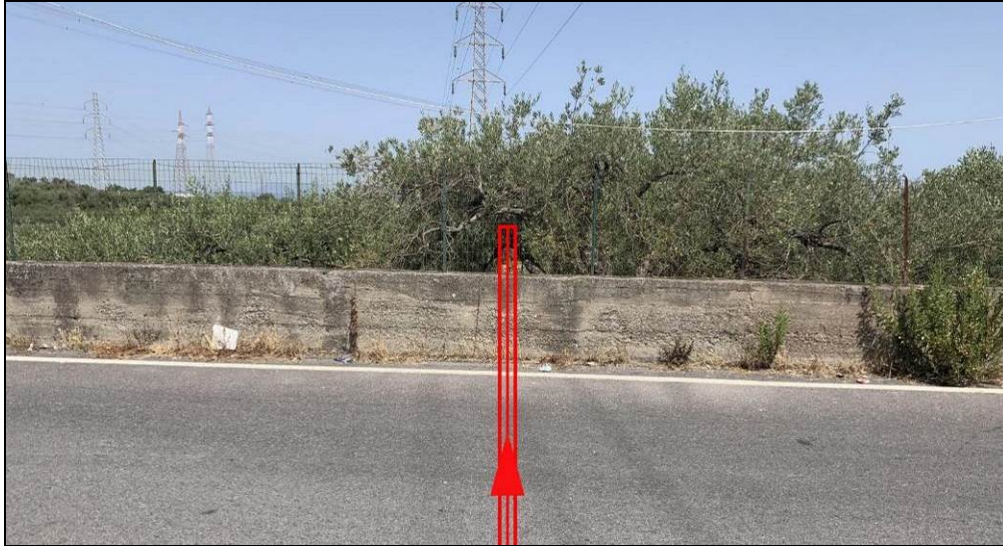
/E – Vista senso gas dell'attraversamento Via Pizzocroce (S.P. n.66) in trivellazione
